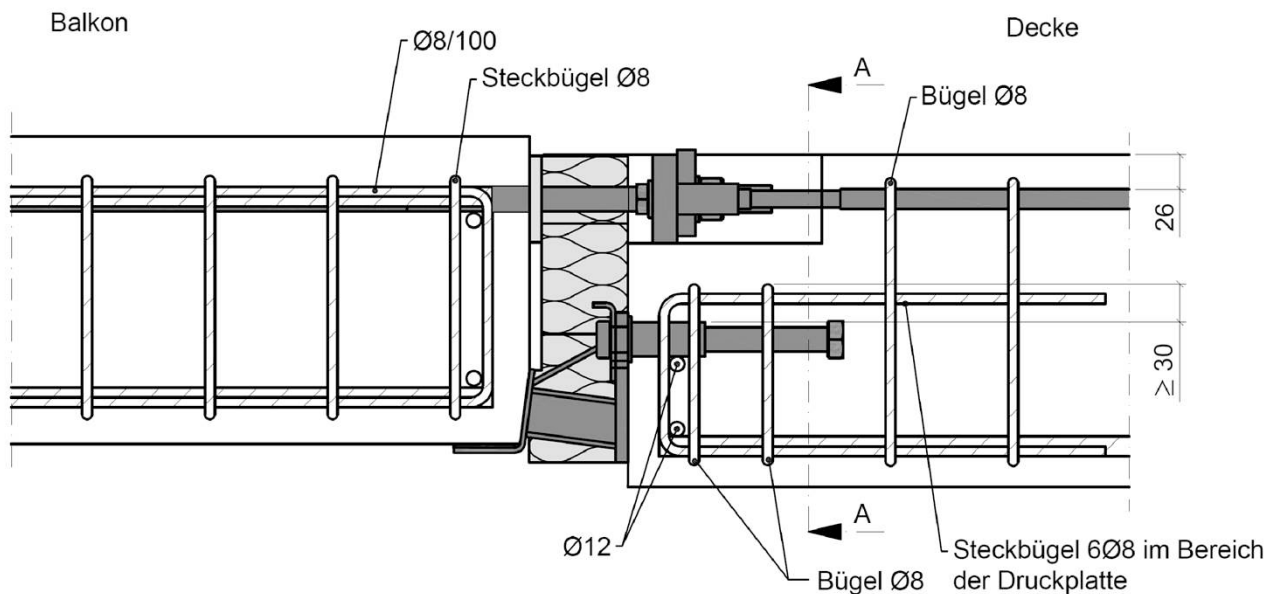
Bauseitige Bewehrung für die Ausführungsvariante A
